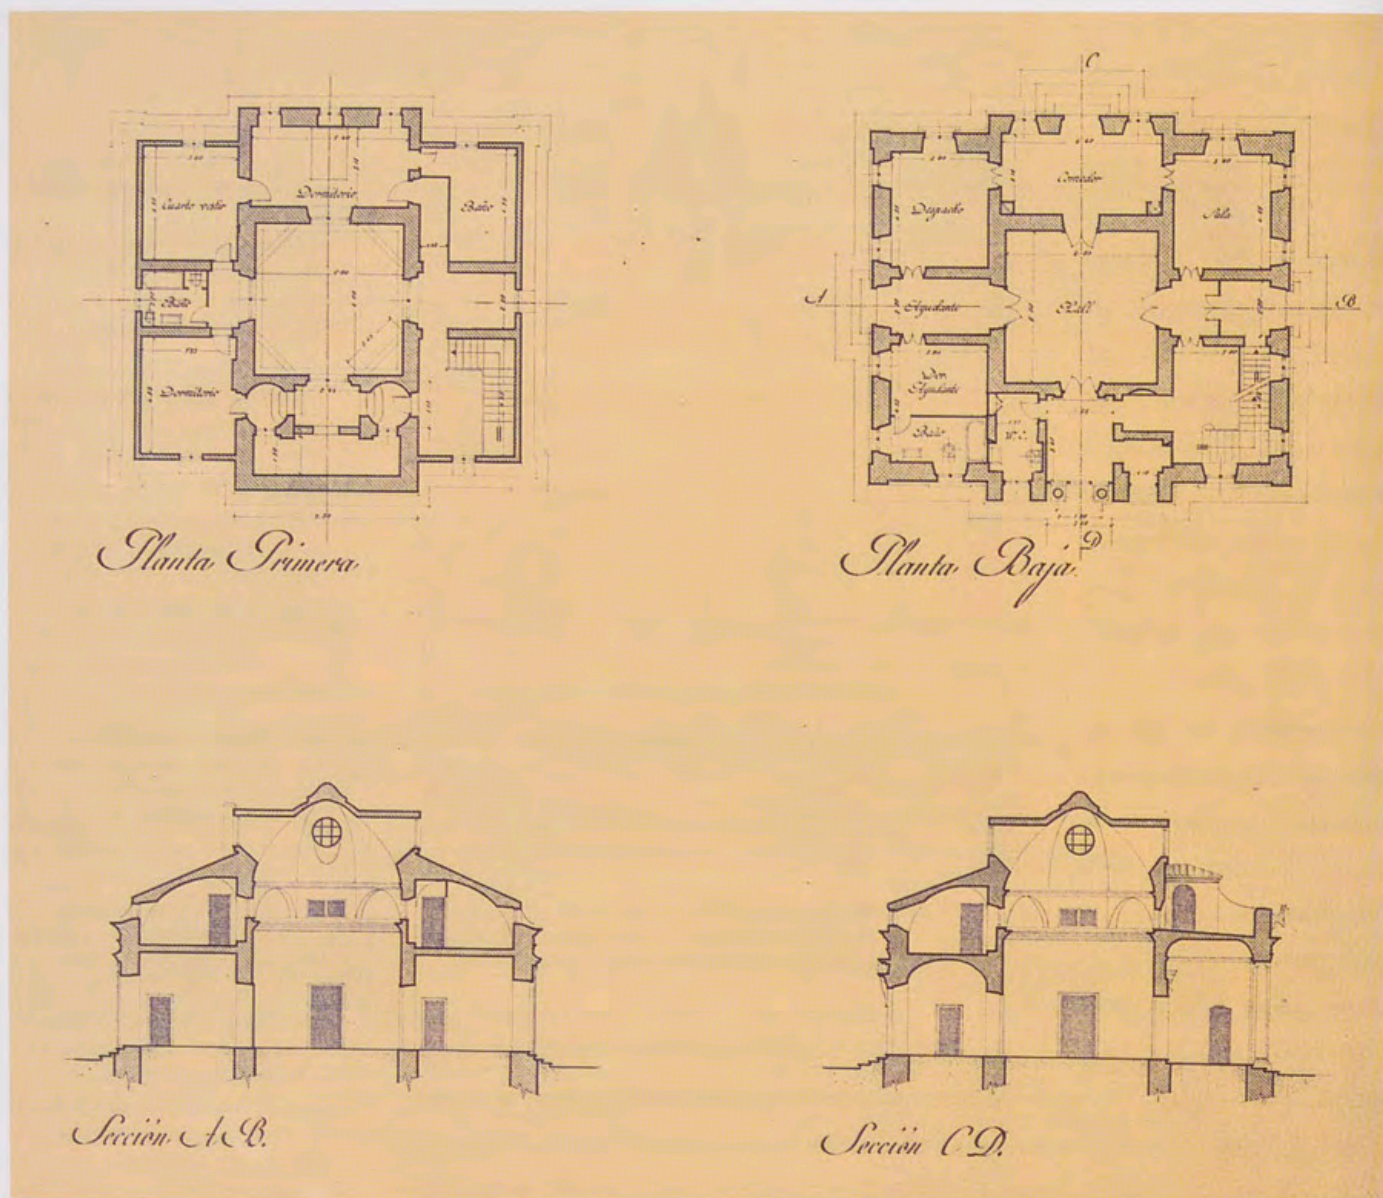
Diego Méndez (copia), Levantamiento de la Casa de Arriba, en el estado anterior a su reforma. Detalle: plantas baja y primera, secciones A-B (transversal) y CD (longitudinal). Madrid, octubre de 1941. Archivo General de Palacio, Planos, nº 5532, Patrimonio Nacional.
